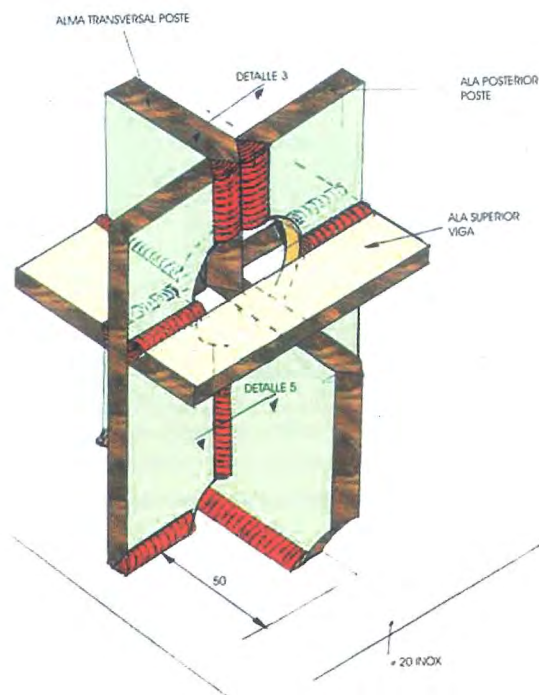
Soudure des cadres raidisseurs / Welding of stiffening frames
